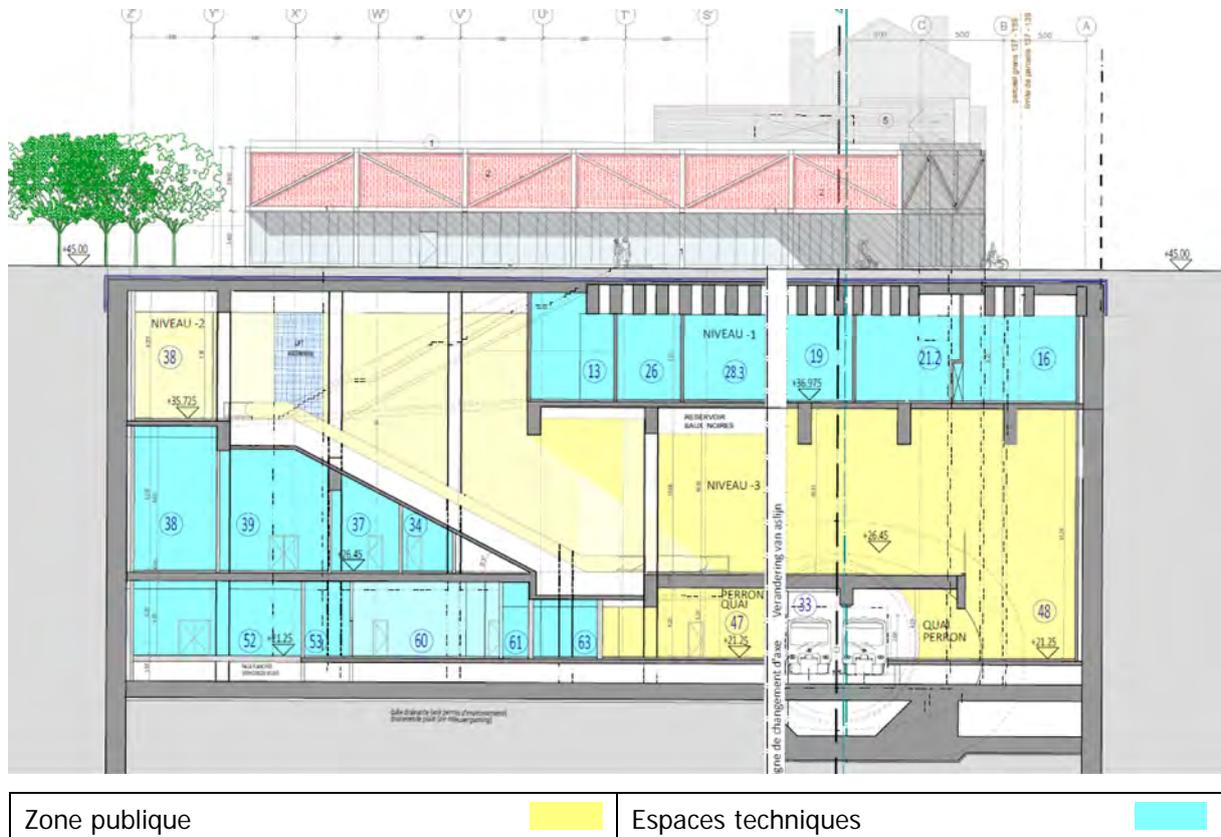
Station Paix, coupe transversale (BMN, 2018)
